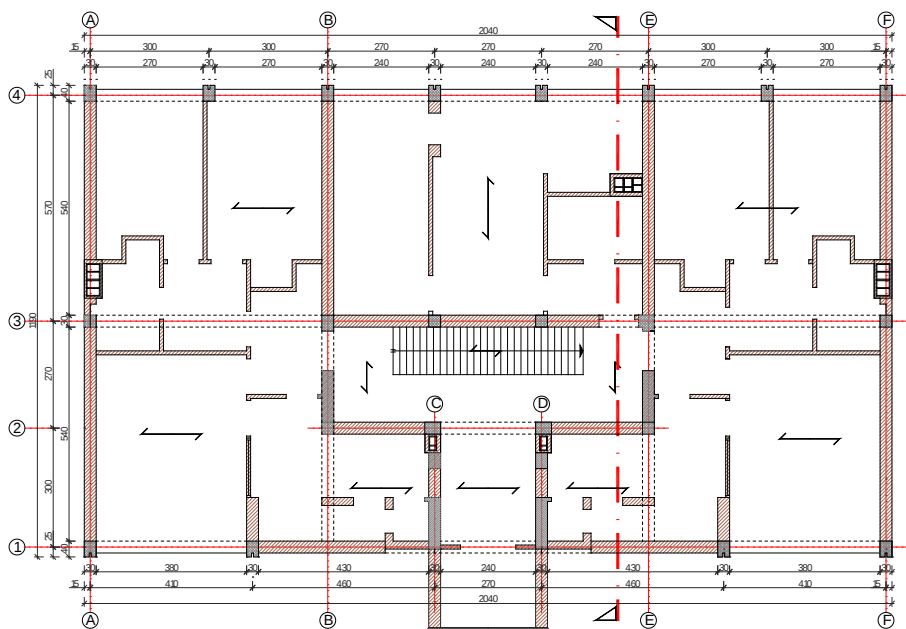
Planimetria e katit karakteristik të ndërtesës E31, RC1H – Ram BA.
